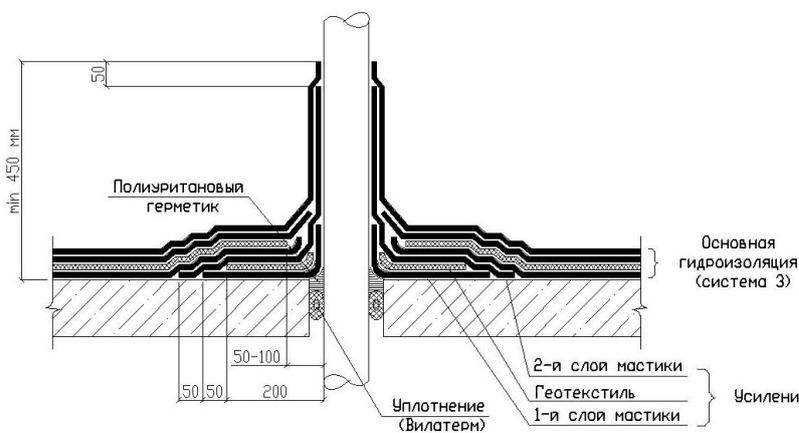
Устройство гидроизоляции примыкания кровельного покрытия к холодным трубам из материалов, обладающих адгезией к полиуретановым мастикам.
